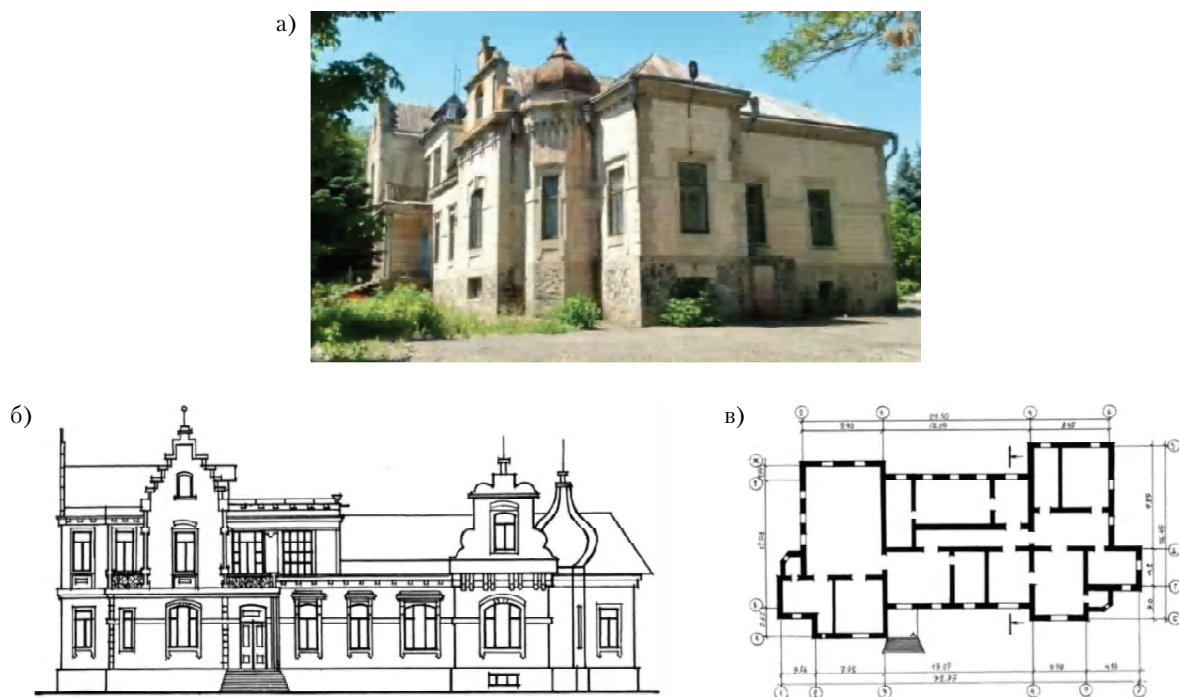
Усадьба помещика С. Г. Роговского в с. Веровка: а) общий вид дома; б) фасад дома; в) план 1-го этажа дома.
